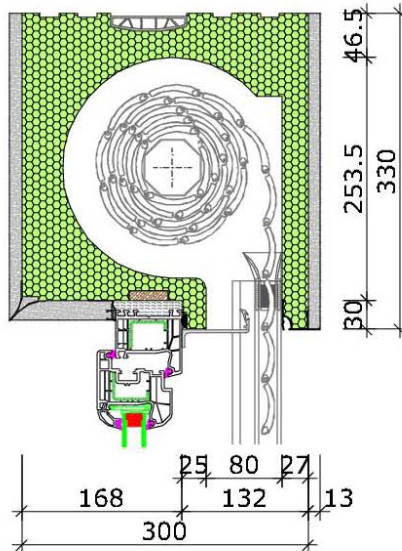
Probekörperdarstellung PK 1 ohne Mauerwerk, Vertikal- und Horizontalschnitt vermaßt.
